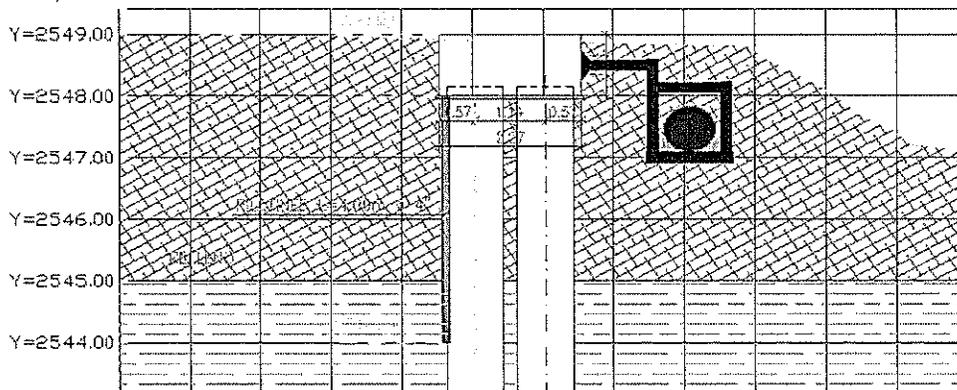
Corte Transversal del Conjunto Muro Pantalla y Soporte de Tubería en tramos donde se presenta cambio de dirección.
